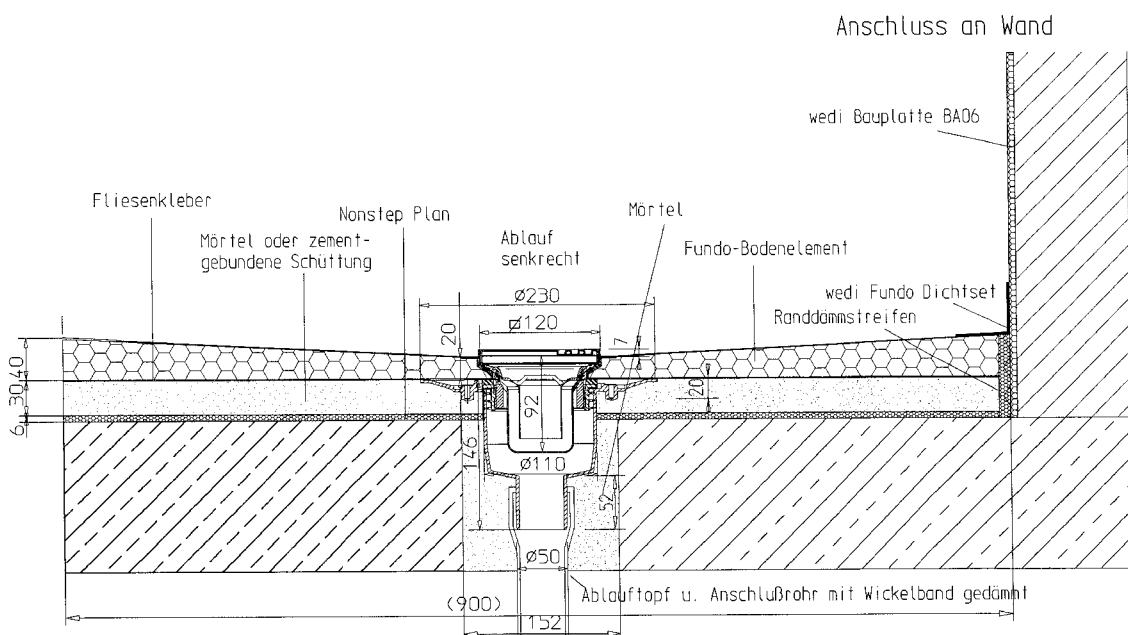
Wedi Fundo mit nonstep plan + Estrich, Ablauf senkrecht
